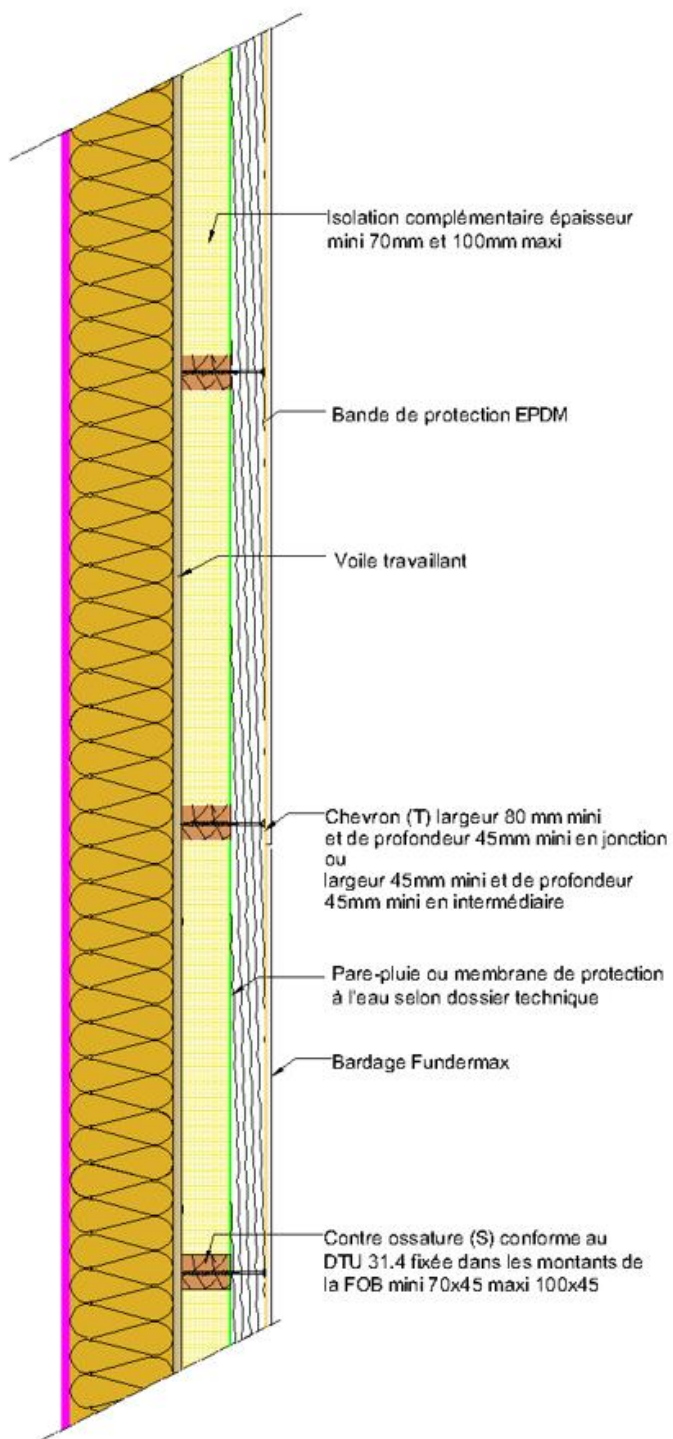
Bardage sur FOB avec contre-ossature (S), coupe verticale
